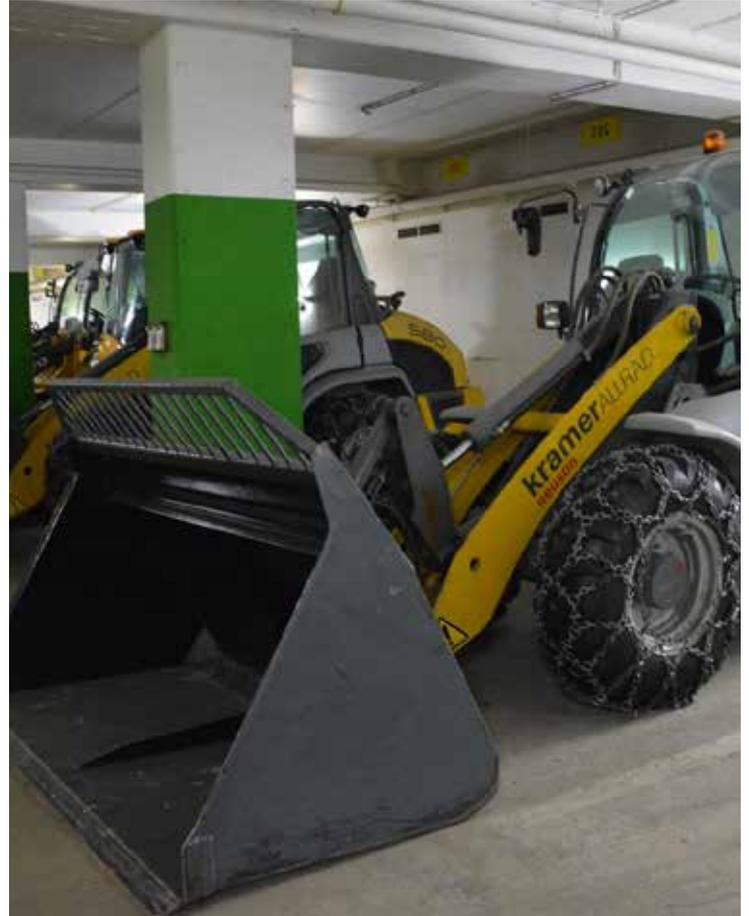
Beanspruchung durch einfahrende Schneeräumfahrzeuge
